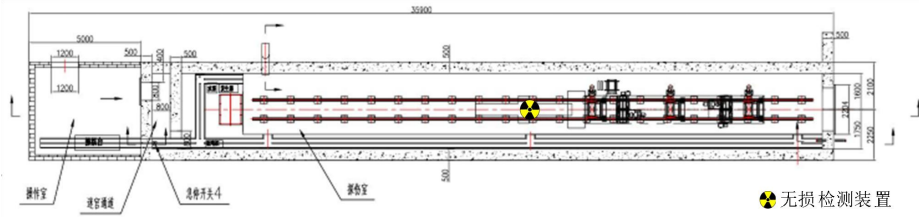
项目 X 射线无损检测装置安装位置示意图（探伤室内总平面图）
